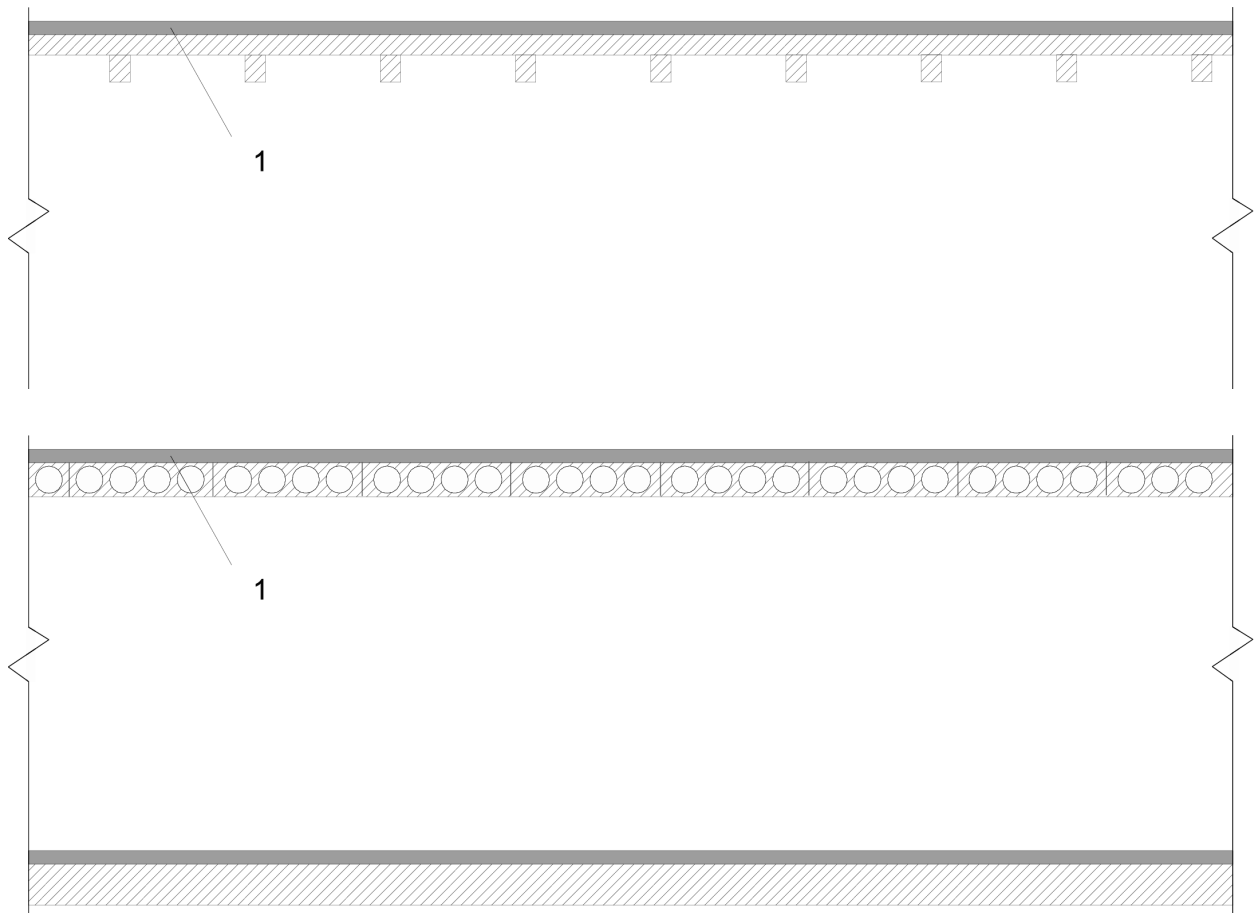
Схема конструктивного решения усиления перекрытия путем намоноличивания слоя железобетона по верху пустотной плиты с заполнением бетоном пустот и установкой в них дополнительной арматуры (1 — слой монолитного бетона сверху)
